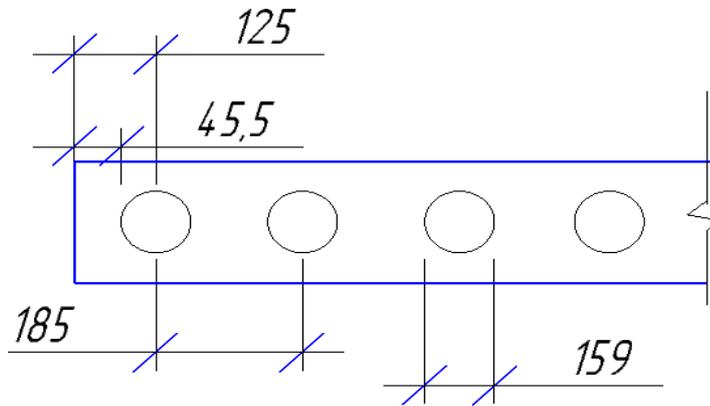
Поперечное сечение железобетонной многопустотной плиты
